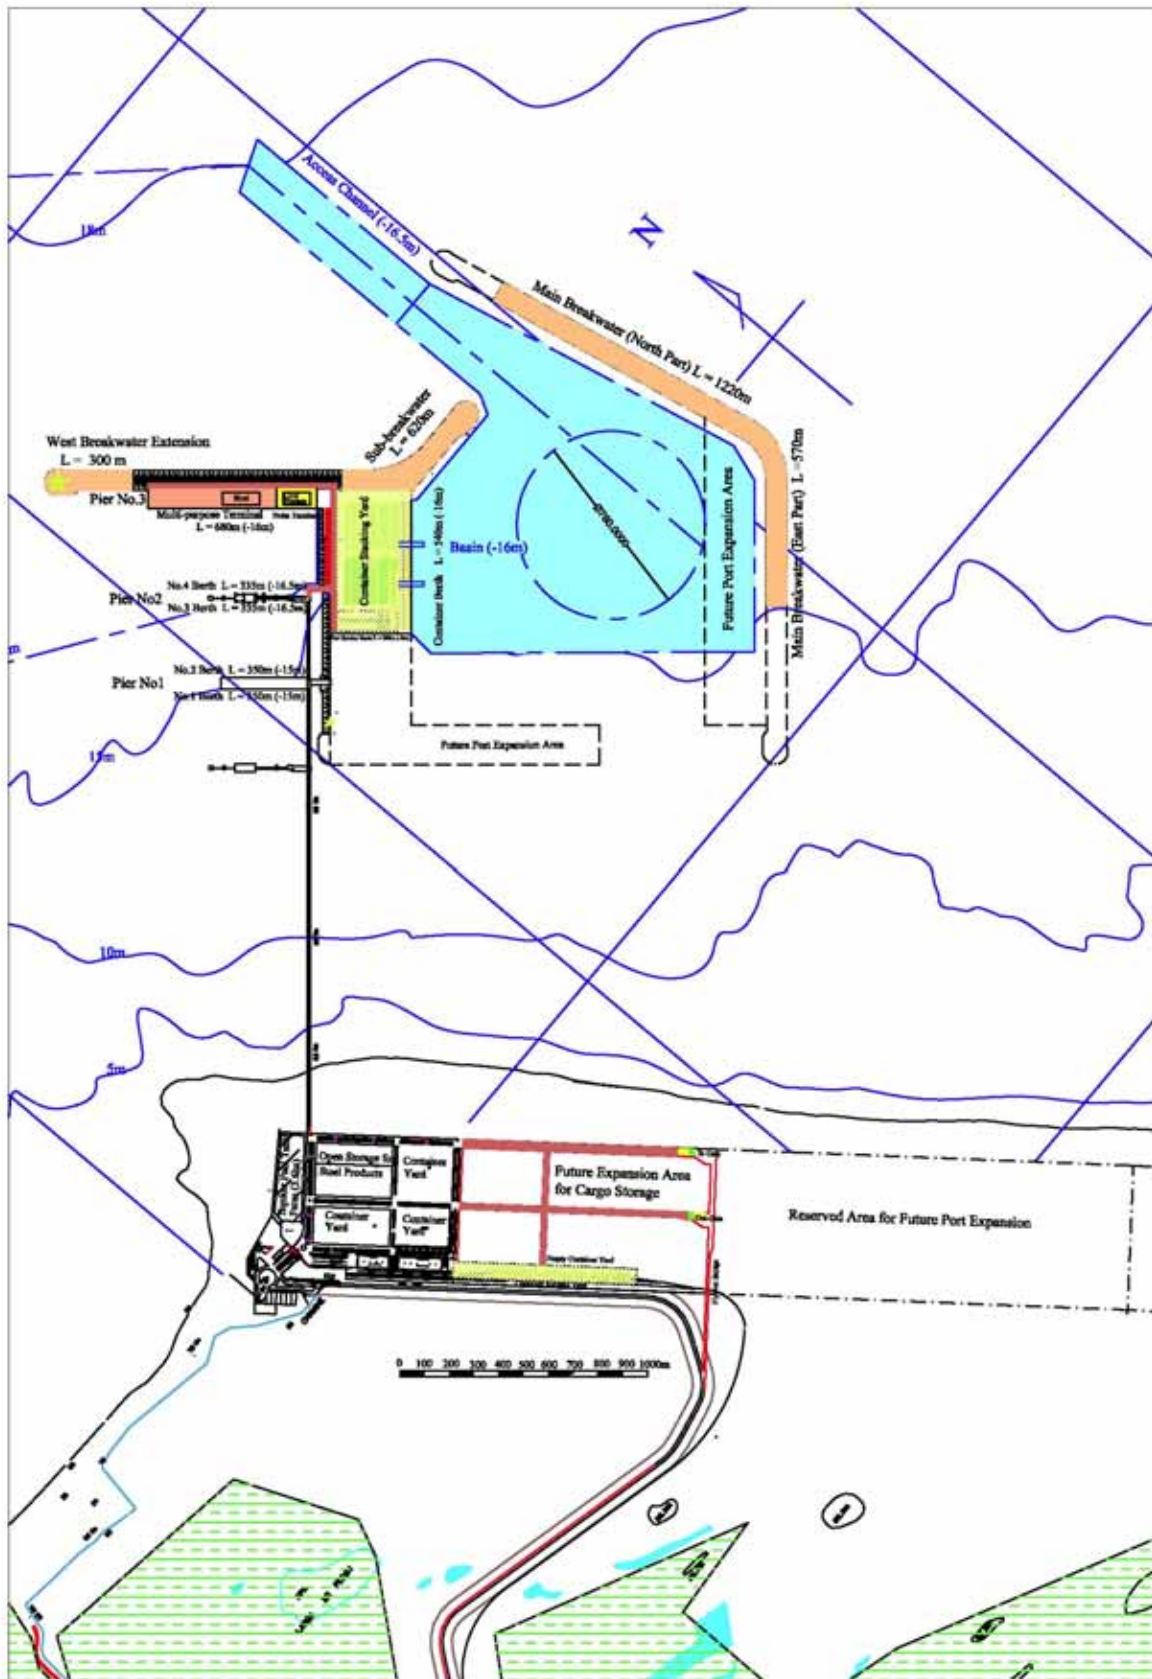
Projeto de *Layout* da Instalação no Plano de Desenvolvimento de Curto Prazo
